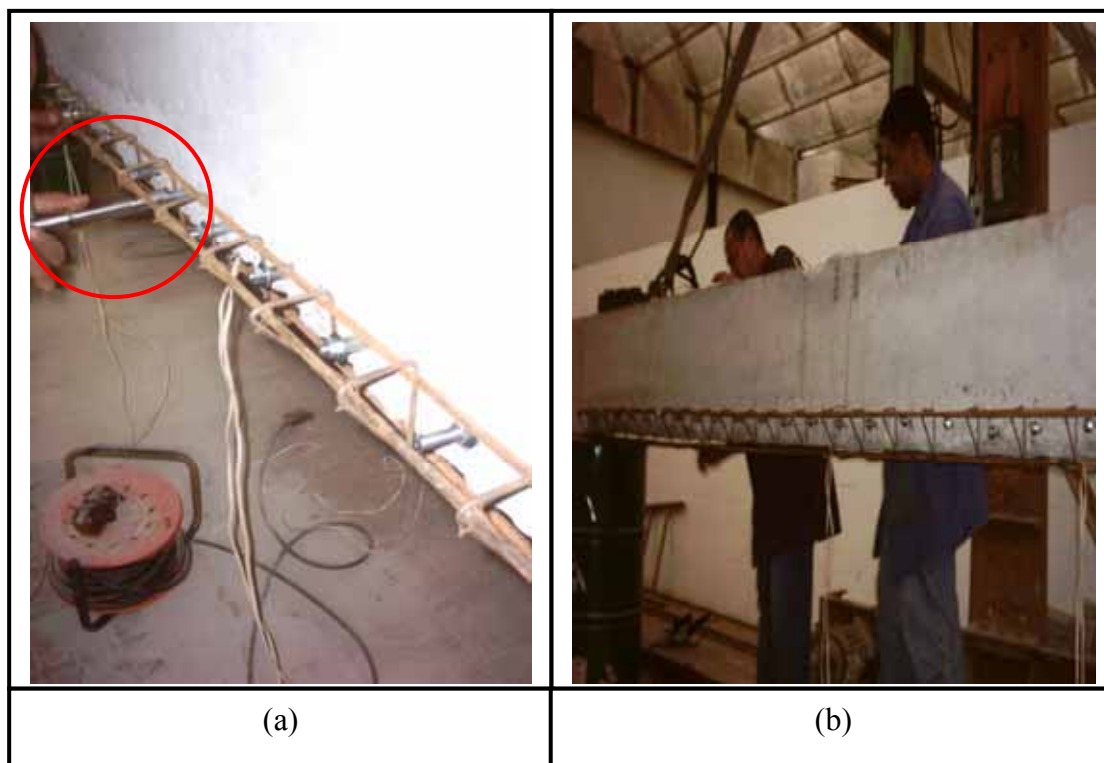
Operação de fixação dos chumbadores nas vigas (a) e chumbadores fixados em um lado da viga (b).
